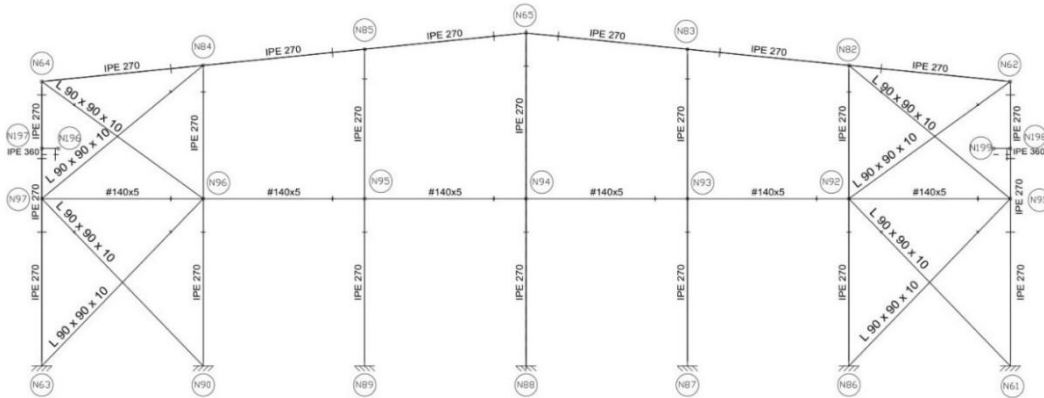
Pórtico de fachada. Fuente: Elaboración propia
